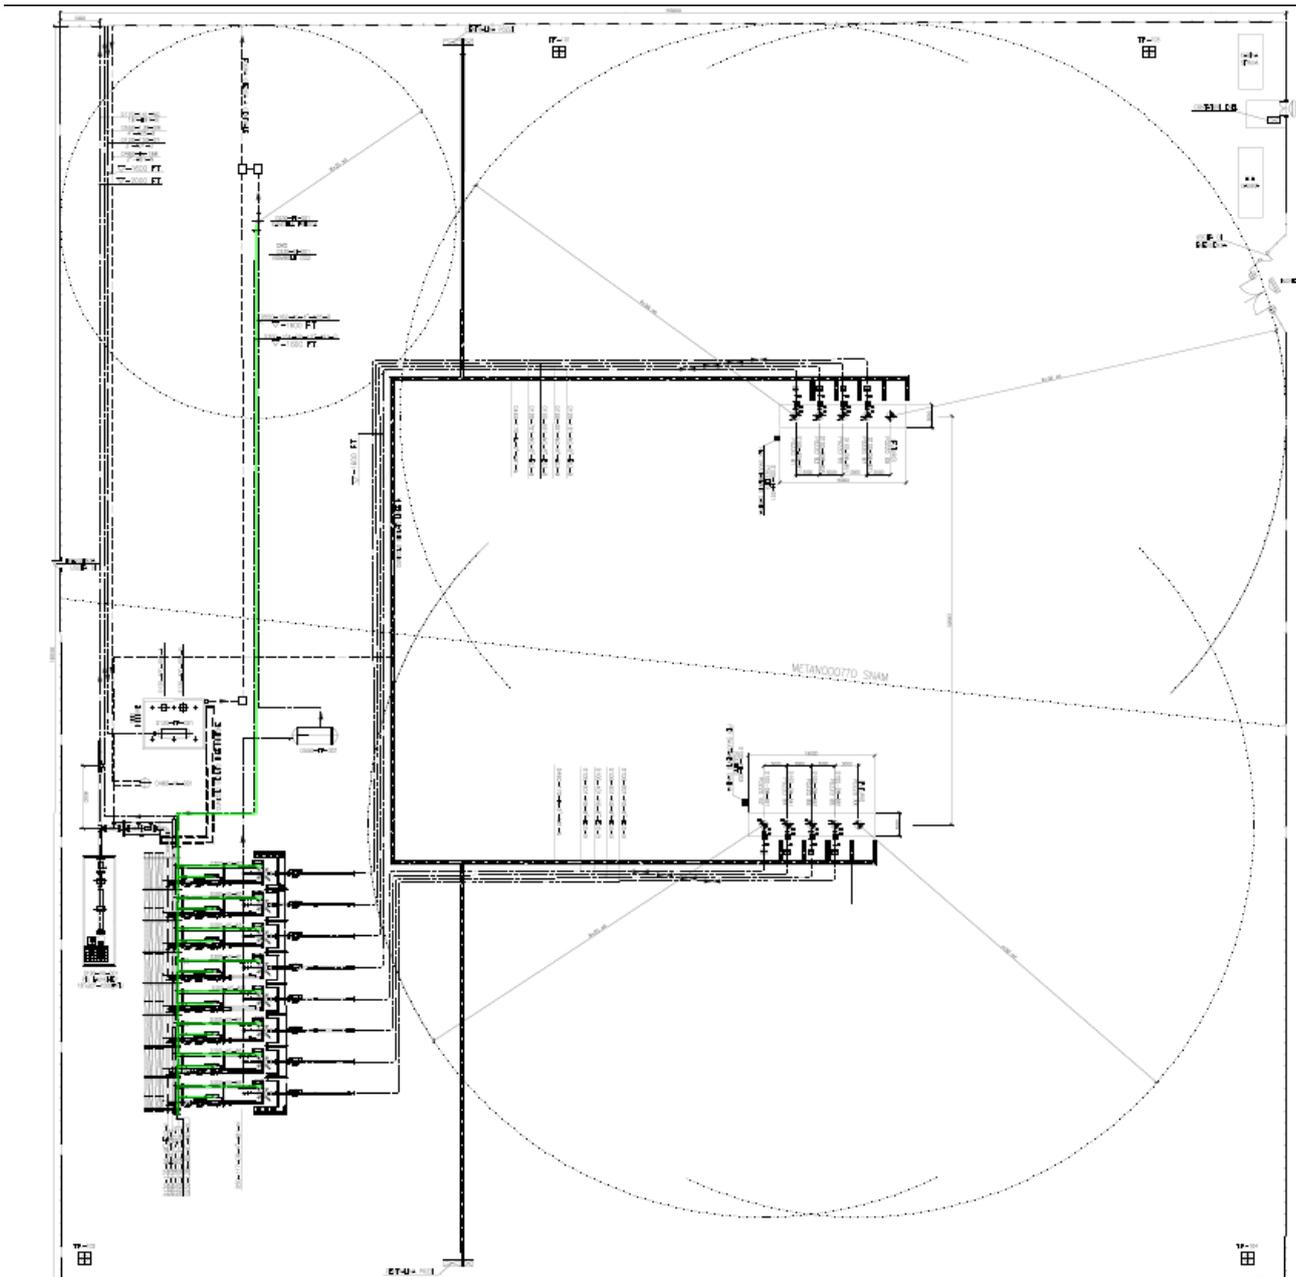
Planimetria andamento tubazioni- Collettore per BDV e PSV
